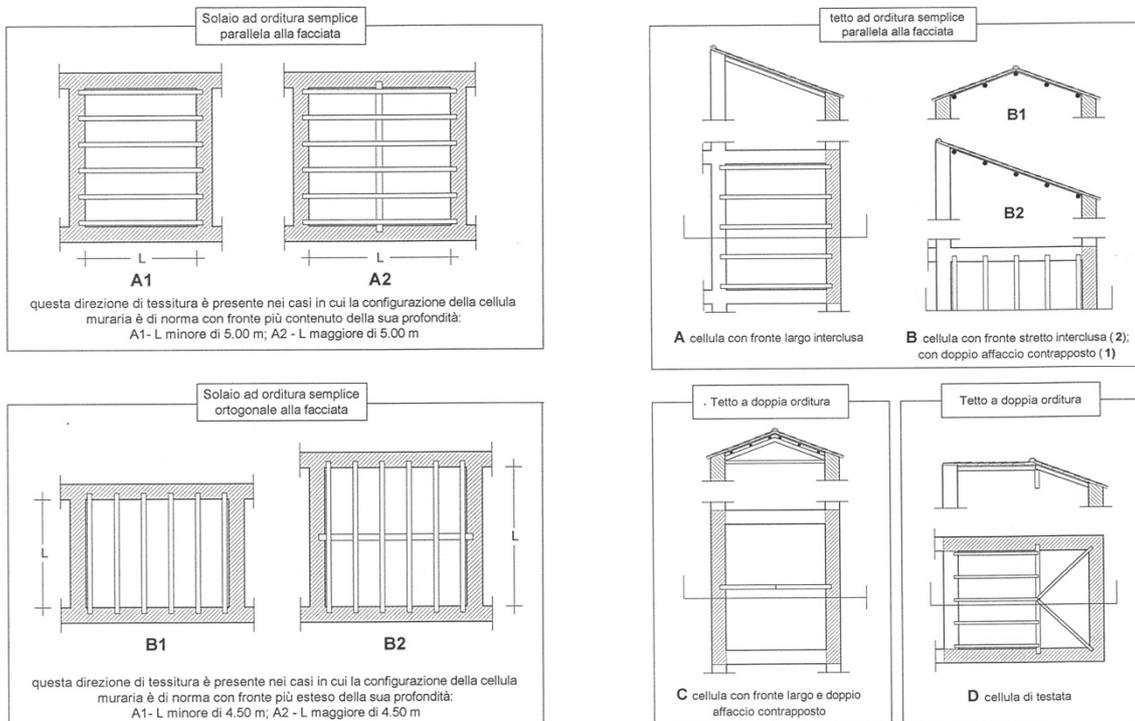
Possibili disposizioni delle orditure lignee di solai e tetti negli edifici murari. La direzione (parallela o ortogonale) delle travi rispetto alla parete di facciata dipende dalla configurazione della cellula muraria.
